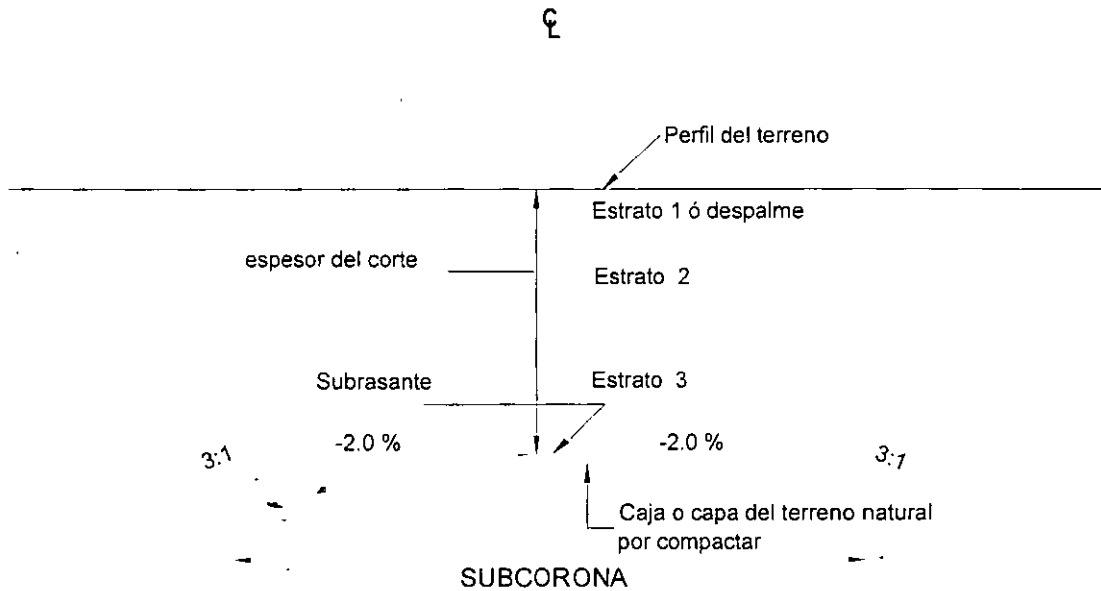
SECCION DE CONSTRUCCION DE UN CORTE EN TANGENTE
